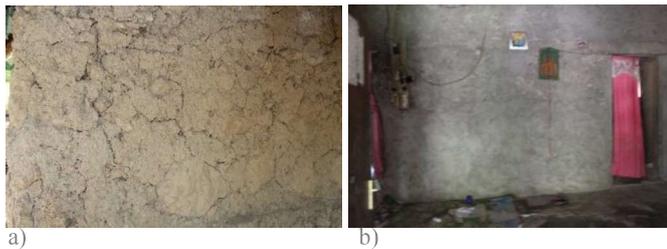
38. Revestimento exterior e interior das paredes. a) Reboco da parede exterior com argamassa terra casa 1 b) Reboco da parede interior com argamassa de cimento casa 5.
